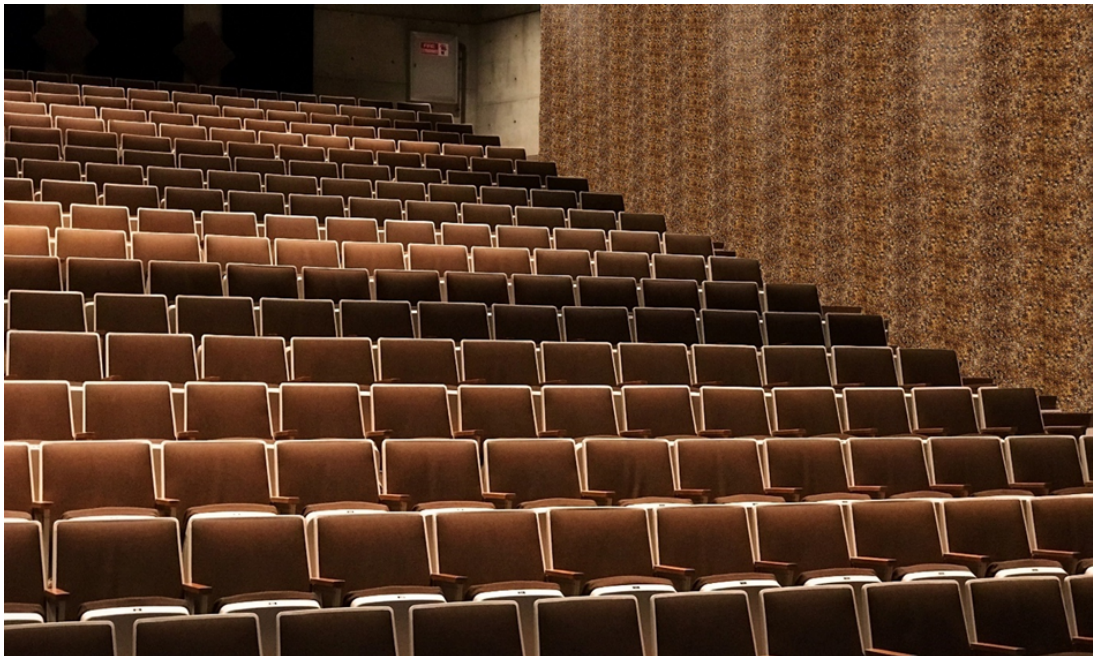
Auditorio con sistema constructivo PAAT.
